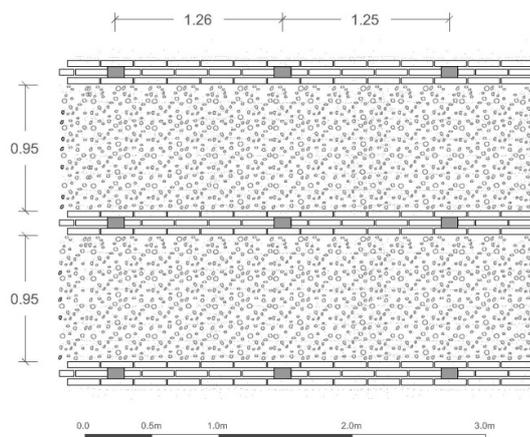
Detalle del muro de la nave de la iglesia de San Boal en Pozaldez. VA.
